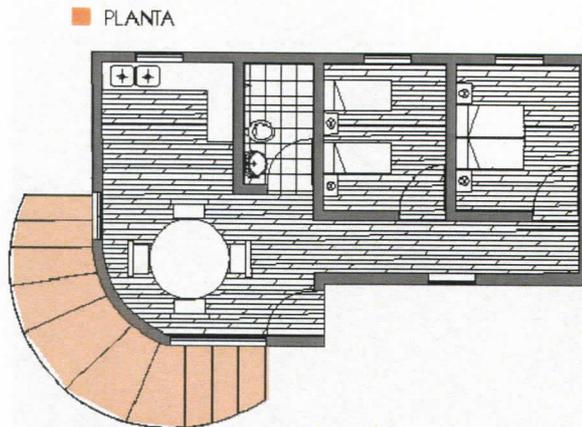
Propuesta de modificación tipológica, utilizando barro. Moreira, Rodríguez y Porta (2008)
